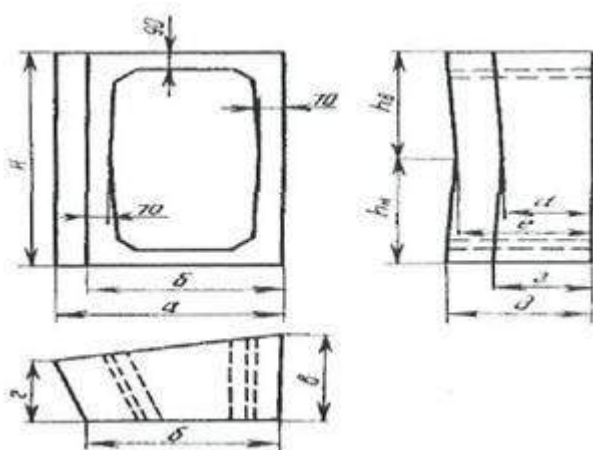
Одноэлементная угловая вставка к сборным железобетонным колодцам типа ККС-3-80(10) и ККС-4-80(10).
